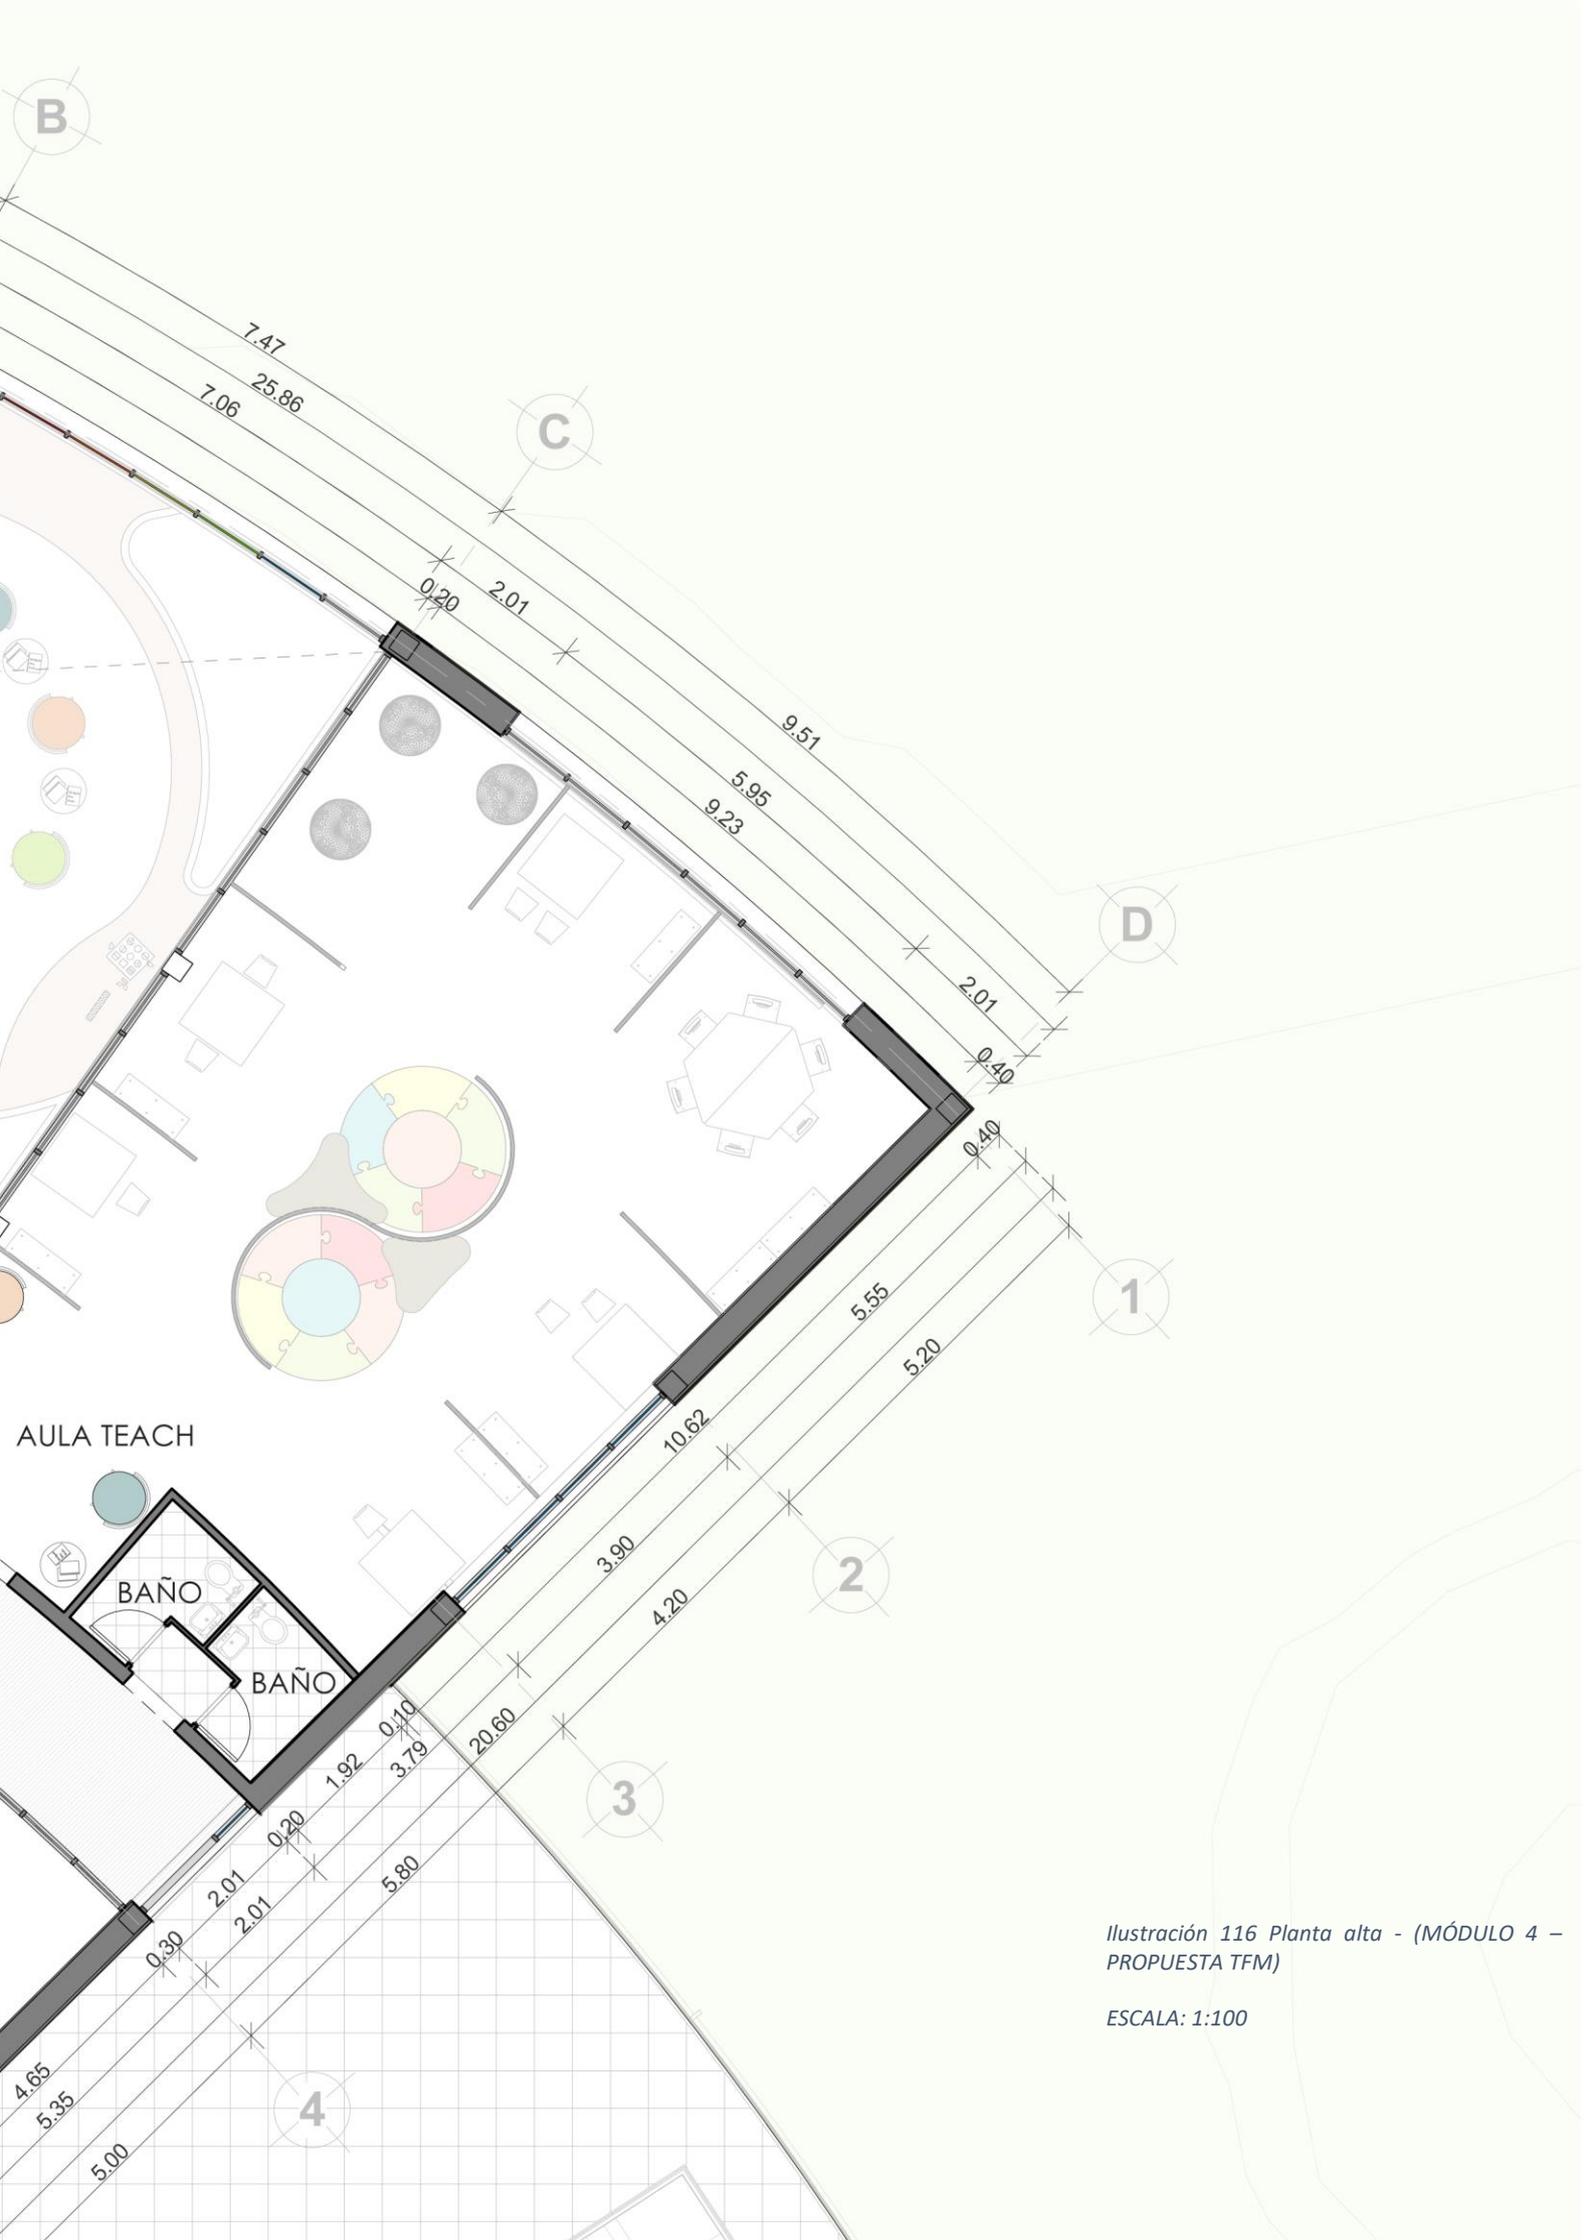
Planta alta - (MÓDULO 4 - PROPUESTA TFM)
